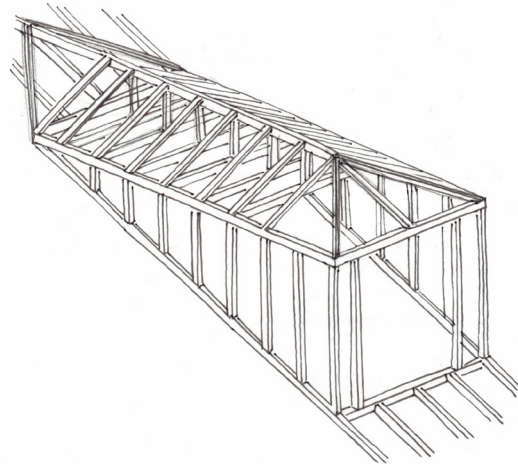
Desenho da estrutura da trapeira, assente sobre as varas;
